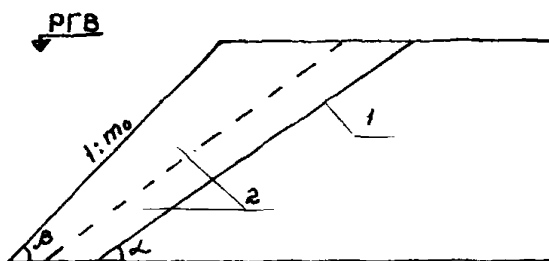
Укрепление откоса насыпи в виде защитной бермы из скального грунта:
